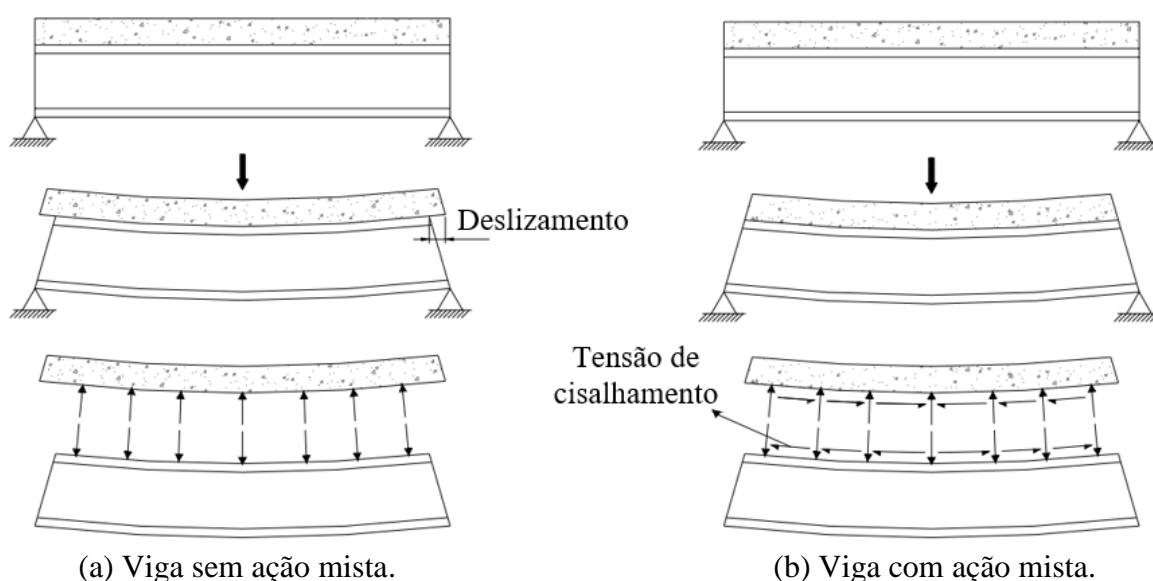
Viga híbrida e viga mista sujeitas a flexão (David, 2007).
